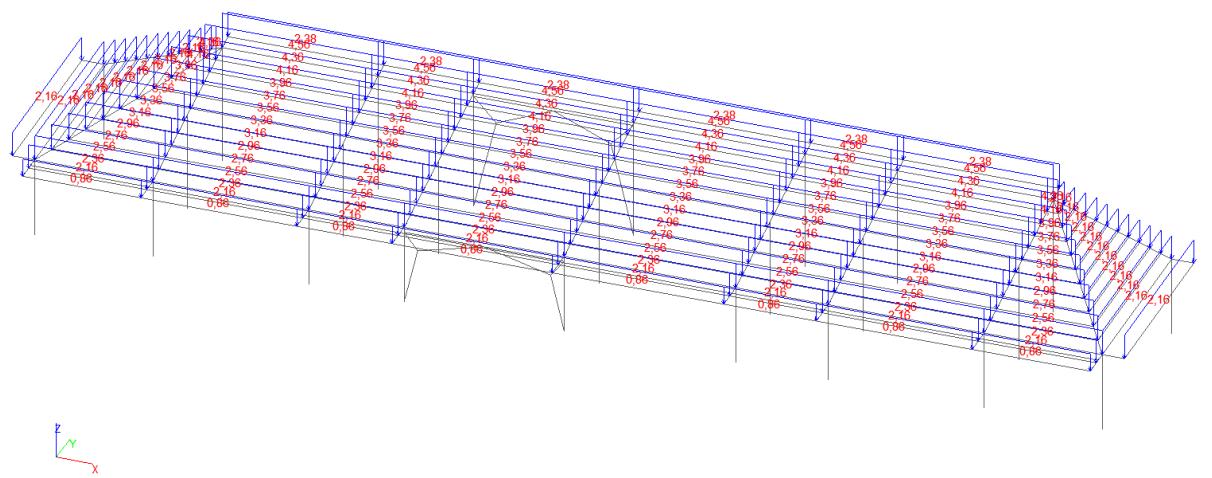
Схема загружения каркаса расчётной снеговой нагрузкой
